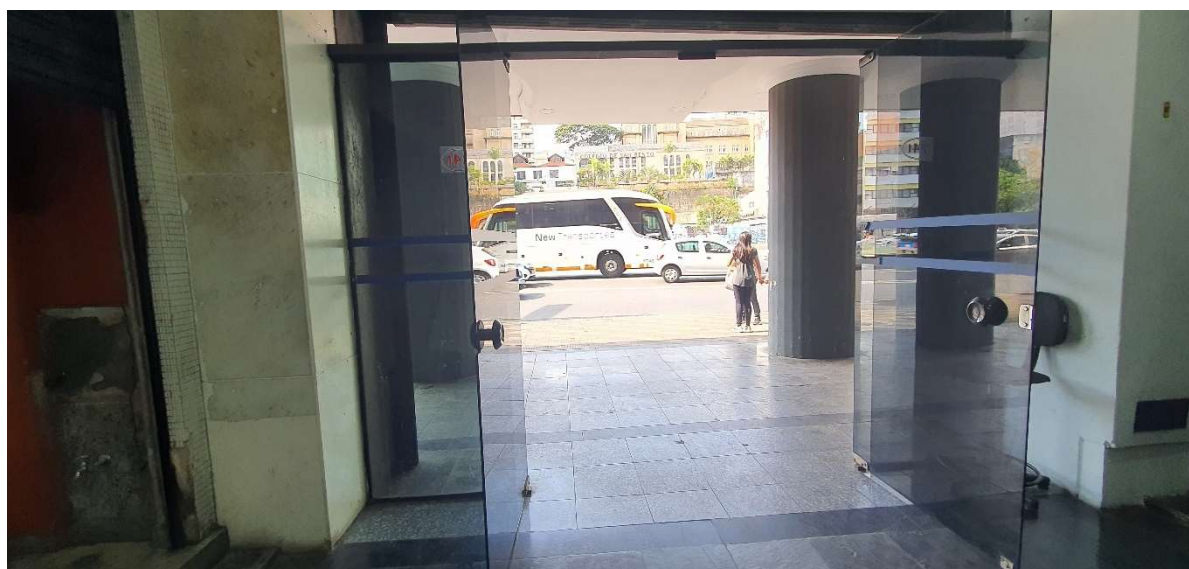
VISTA OPOSTA DA PORTA DE ENTRADA.
